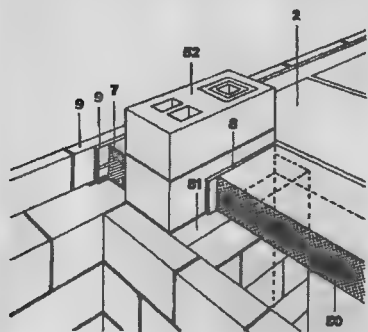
На рисунке показаны: дымоход, вырез в перекрытии, заделочные и стеновые блоки, панели перекрытия:
